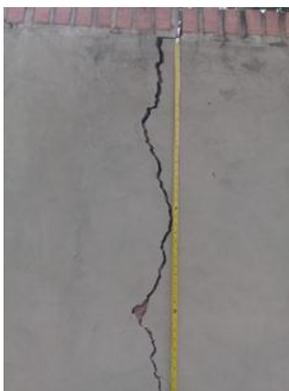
GRIETA EN ESQUINA MURO CIERRE
